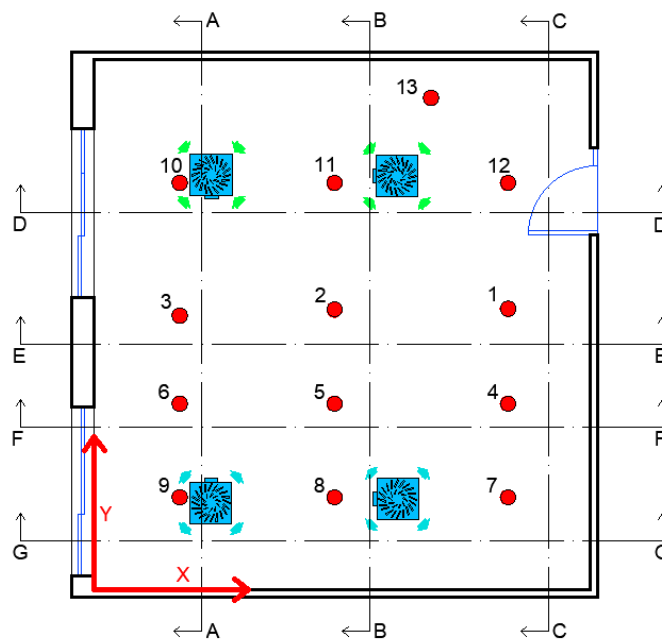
Planimetria aula 10 Recanati con individuazione di tutti i punti di presa, sezioni e impianto di ventilazione con mandata e ripresa aria
